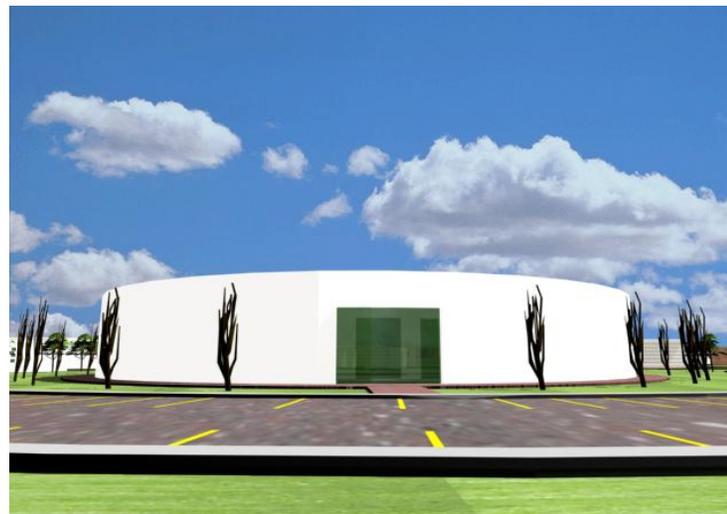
IMAGEN: FACHADA POSTERIOR NORTE DEL MAUSOLEO
